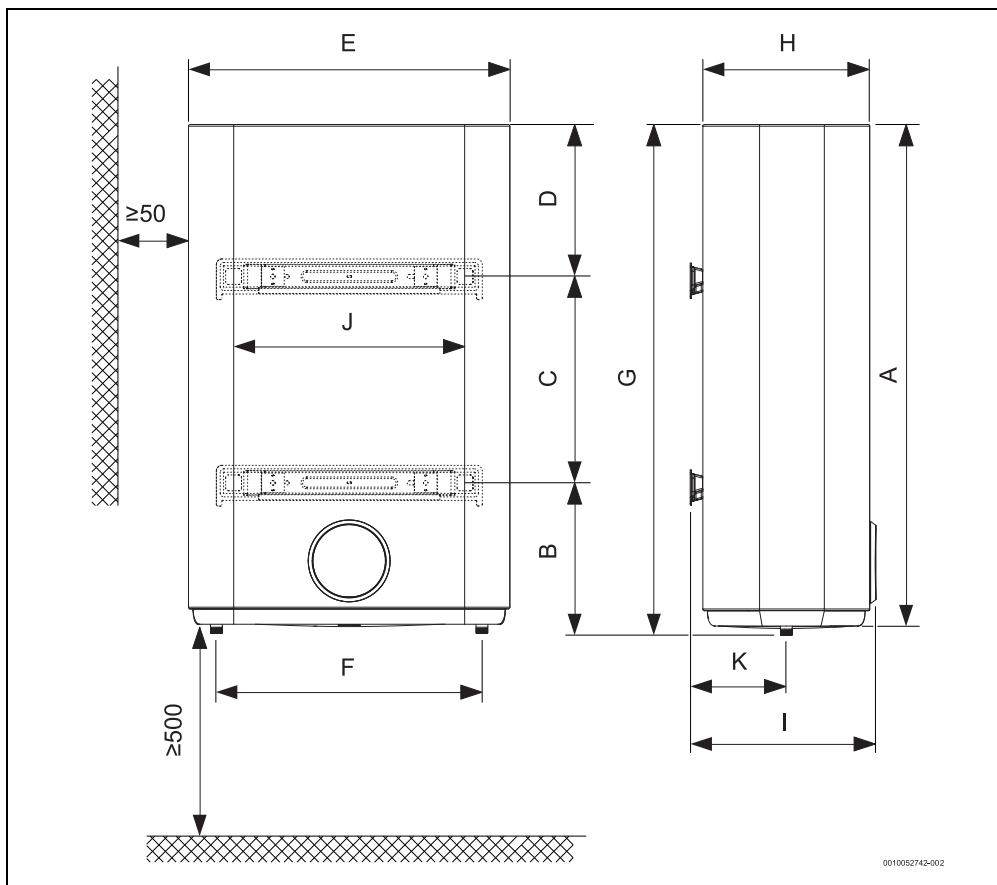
Dimensions en mm (montage mural, installation verticale)
